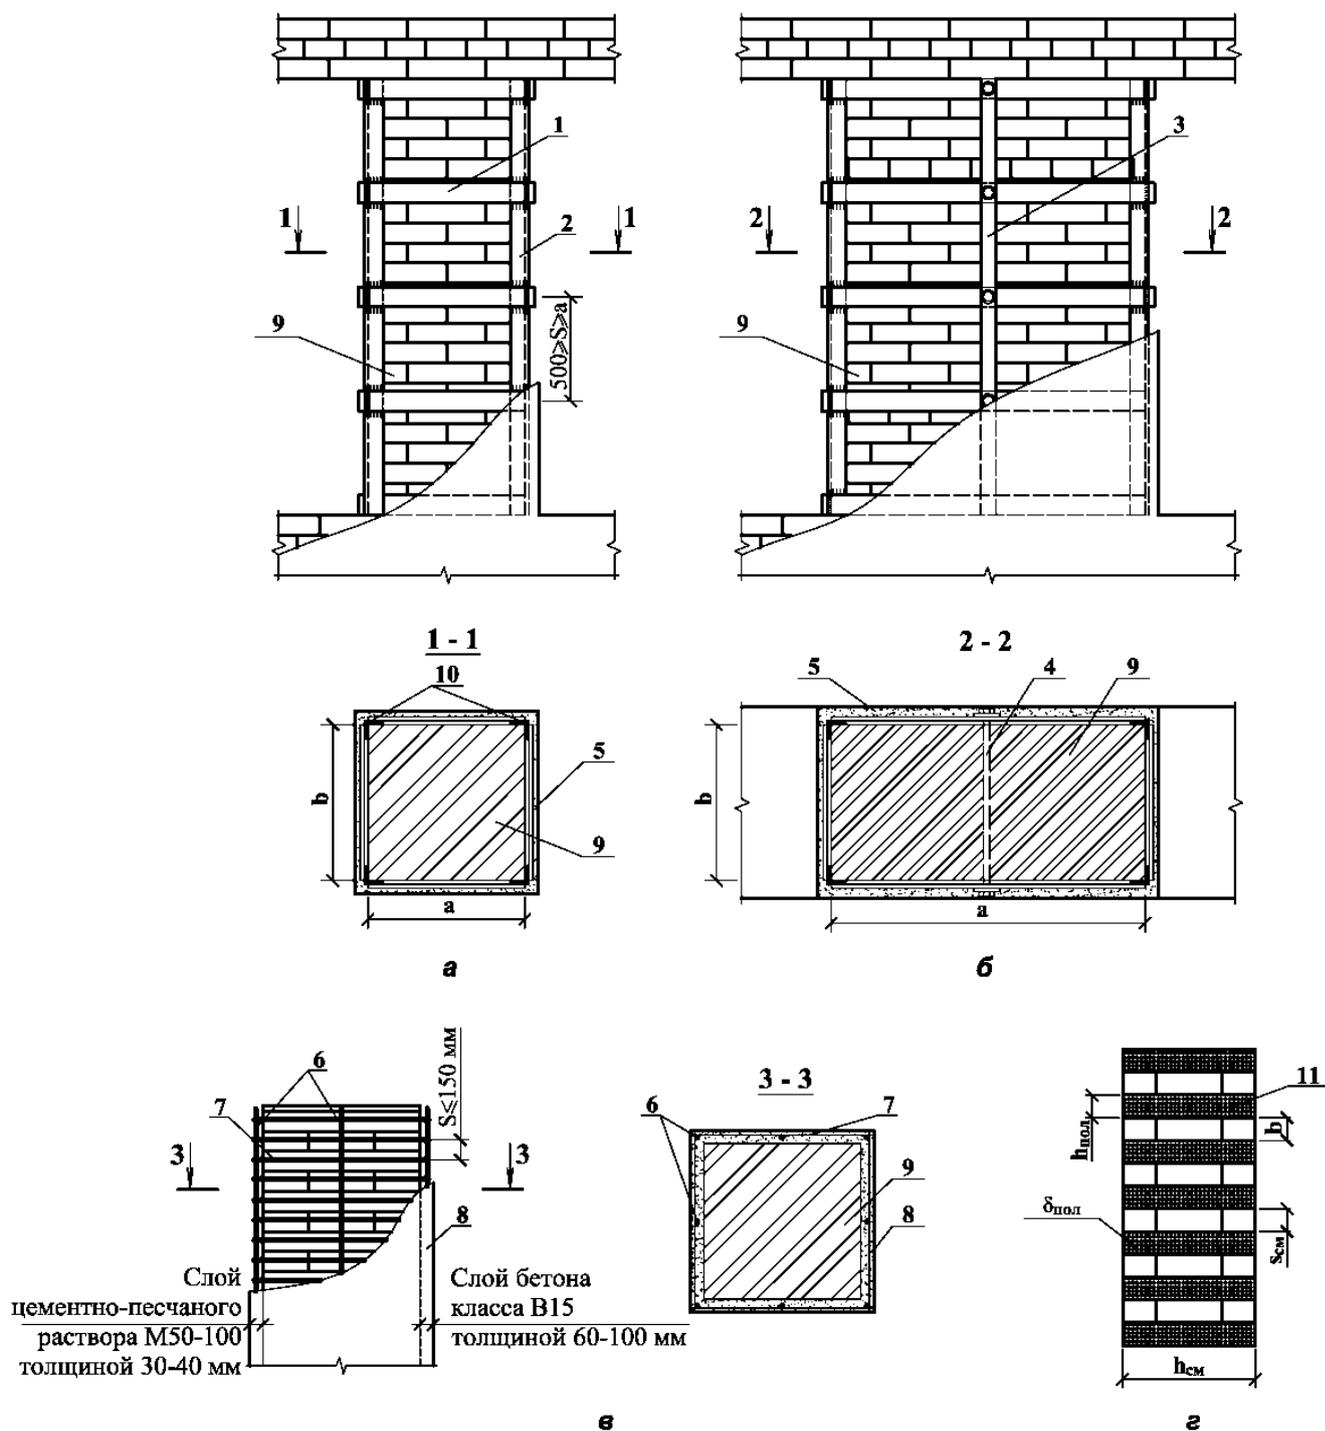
Усиление каменных конструкций устройством обоймы: а – стальной, при соотношении сторон сечения меньше 1:2; б – то же, при соотношении сторон сечения больше 1:2; в – железобетонной и растворной; г – бандажами из углеволокна; 1 – хомуты (планки) из круглой или полосовой стали; 2 – уголки; 3 – промежуточные вертикальные планки из полосовой стали; 4 – стяжные болты; 5 – слой цементно-песчаного раствора; 6 – вертикальная арматура обоймы; 7 – сварные хомуты обоймы; 8 – растворная или железобетонная обойма; 9 – усиливаемый каменный элемент; 10 – слой цементно-песчаного раствора
